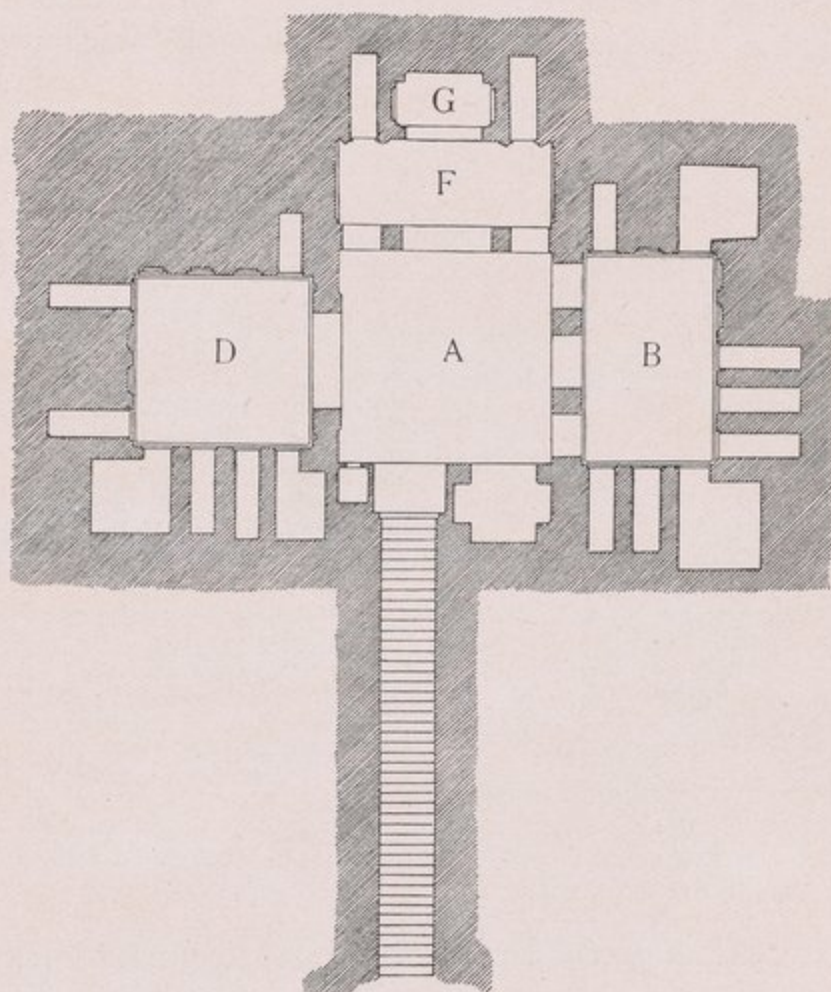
Grundriss des Grabes im Antoniadisgarten. (Nach Schiff.)
